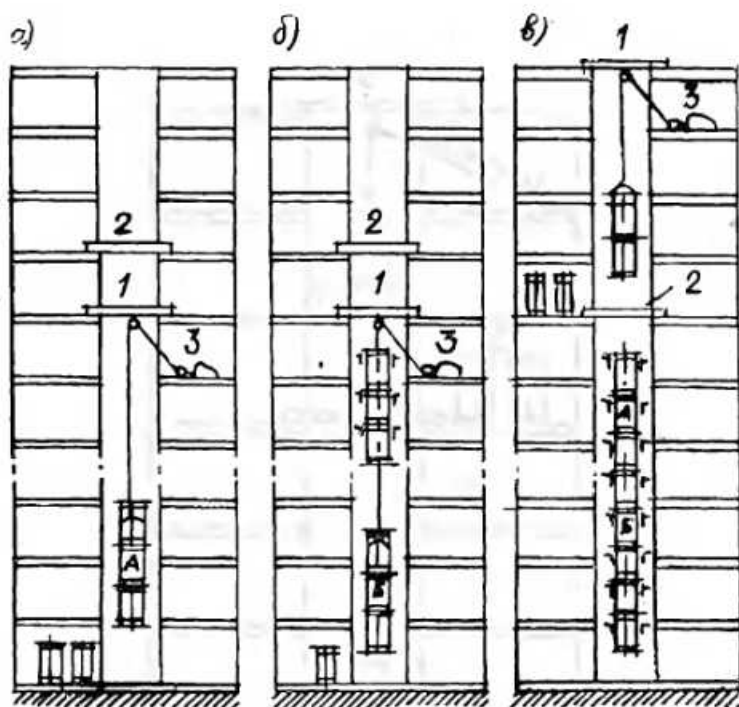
Комбінований спосіб монтажу вертикальних повітропроводів: а) вузла А способом підрошування; б) те ж, вузла Б; в) нарощуванням; 1 - вантажна балка; 2 - настил; 3 - лебідка
